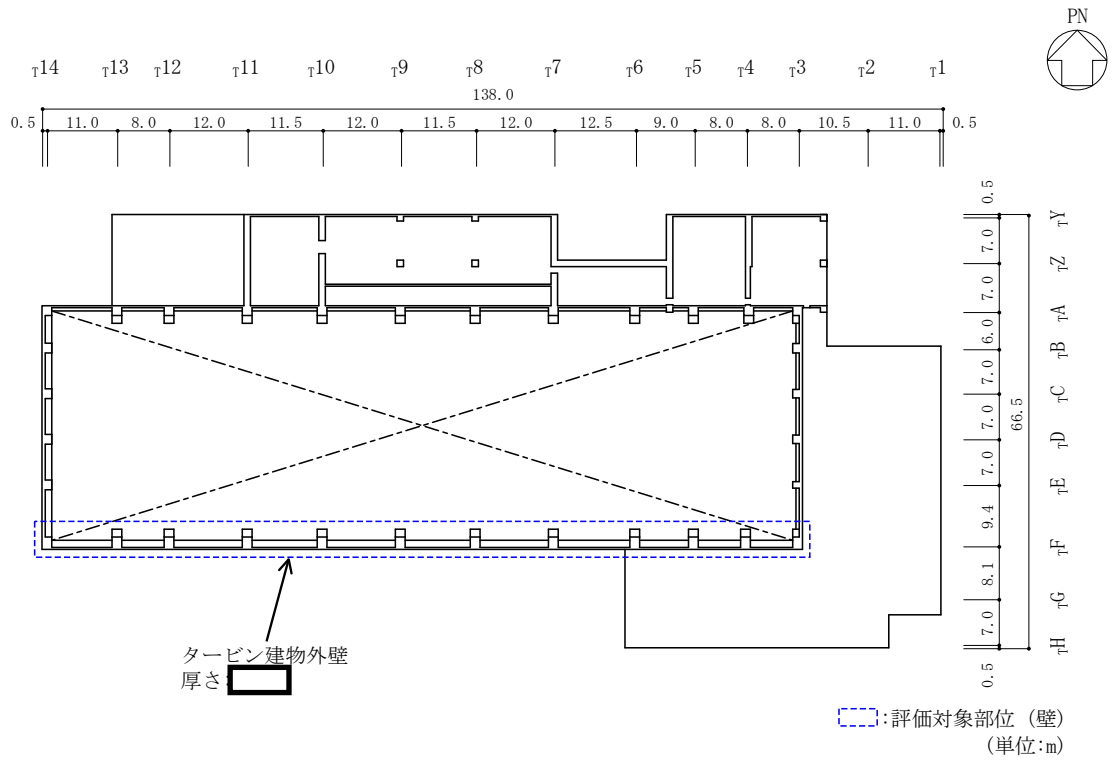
(1) タービン建物の概略平面図 (EL 32.0m)
